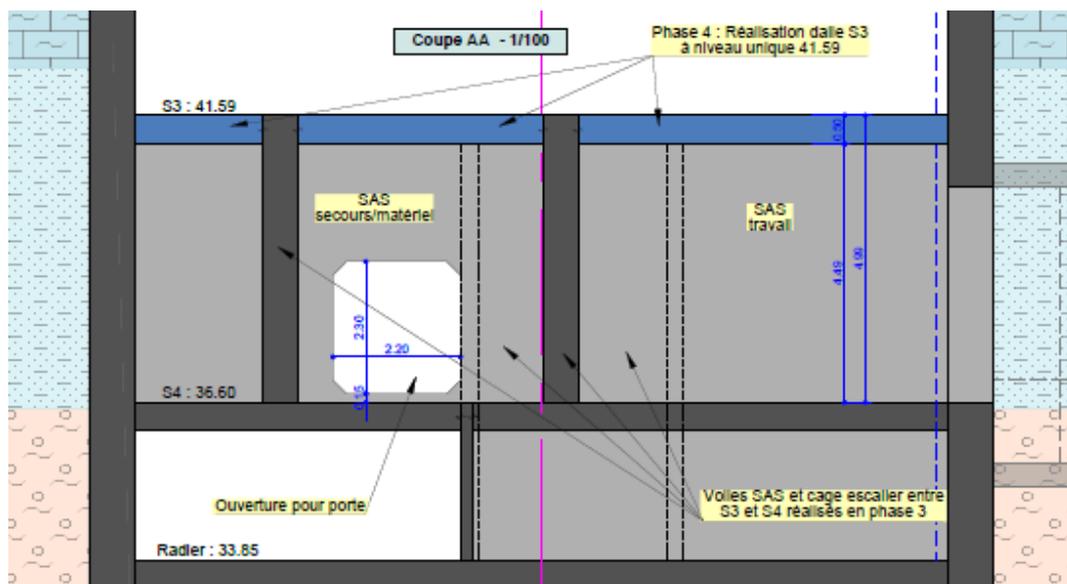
Coupe AA - Dalle S3 (épaisseur 50cm) en un seul niveau
